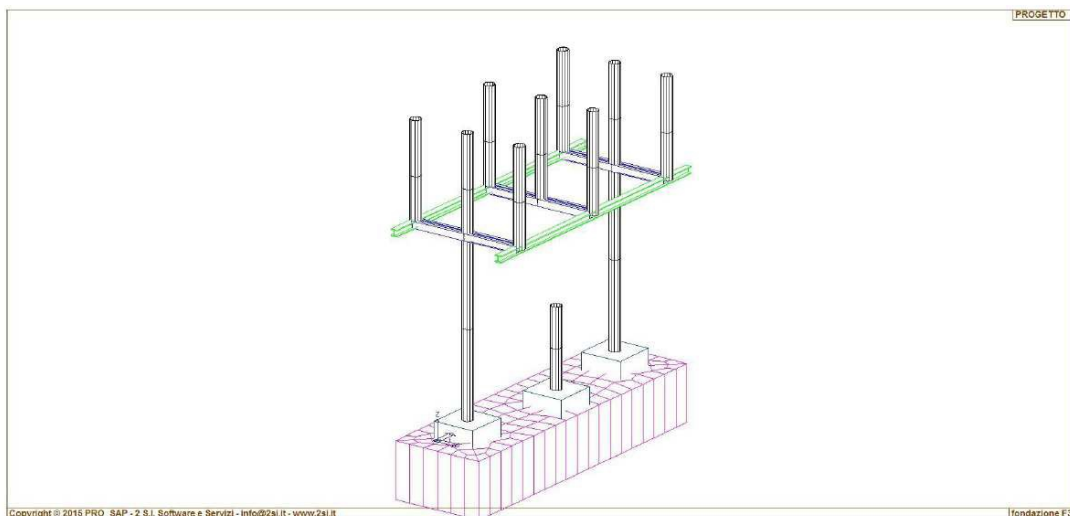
Modellazione Fondazione Terminale Cavo in area Punto di Raccolta ed in area SE TERNA
